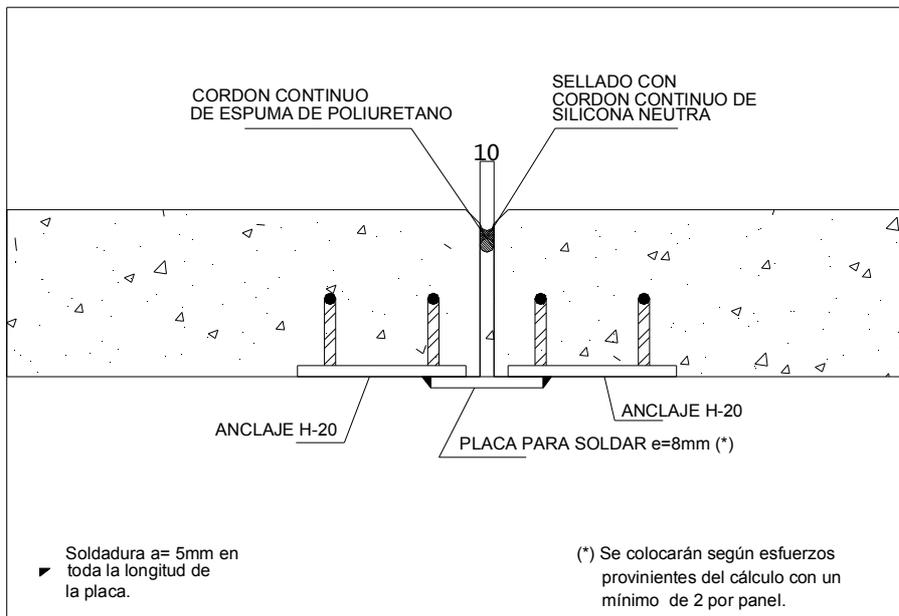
JUNTA VERTICAL ENTRE PANELES
